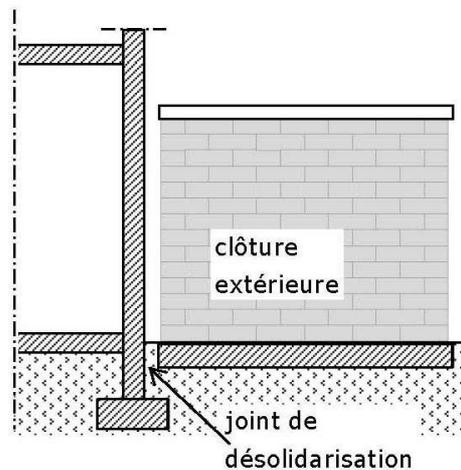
Désolidarisation des fondations des ouvrages secondaires
